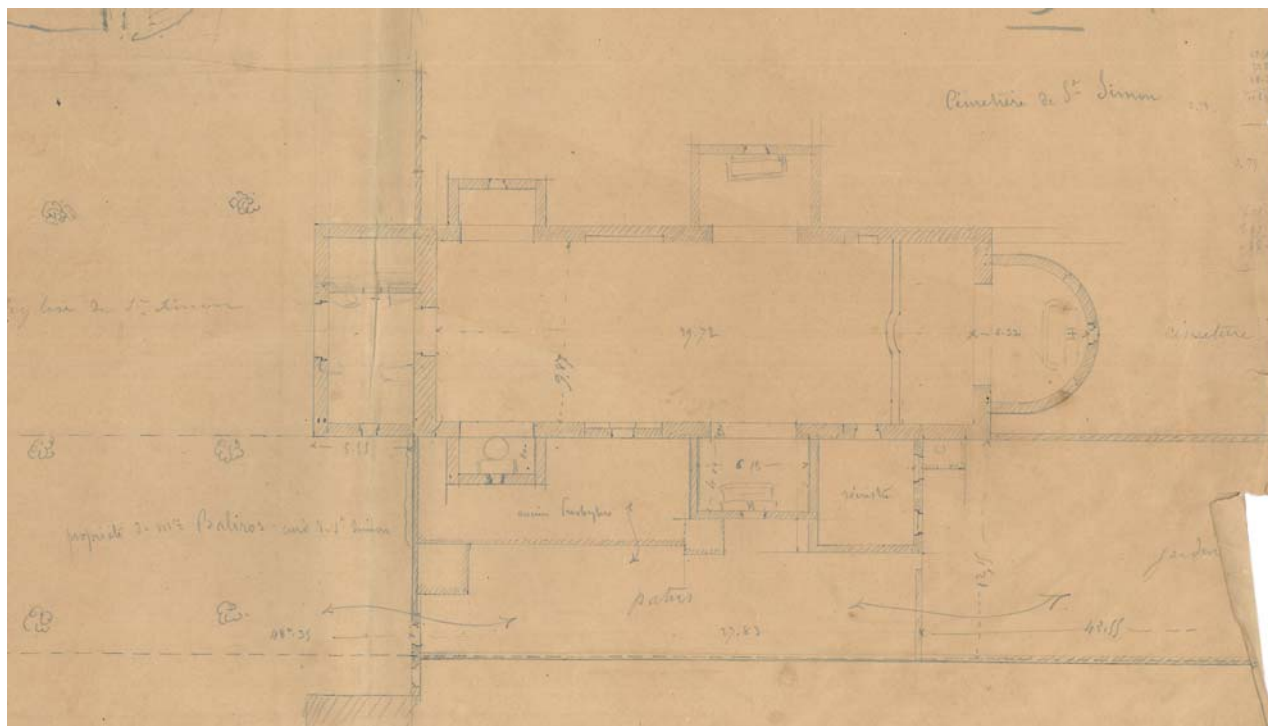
Plan de l'église de Saint-Simon le 4 juillet 1865 et le 19 juin 1866. AMT, 5 M 23/3
